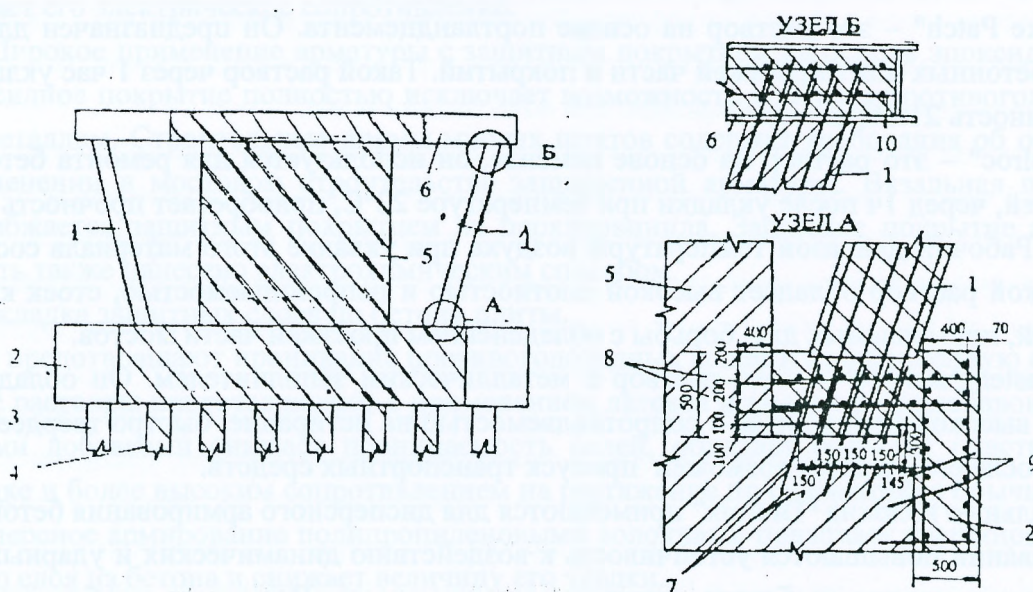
Комплексное уширение и усиление опор: 1 – наклонная железобетонная стойка; 2 – железобетонная рубашка; 3 – дополнительные сваи; 4 – сваи существующей опоры; 5 – тело существующей опоры; 6 – двутавр; 7 – арматурные
